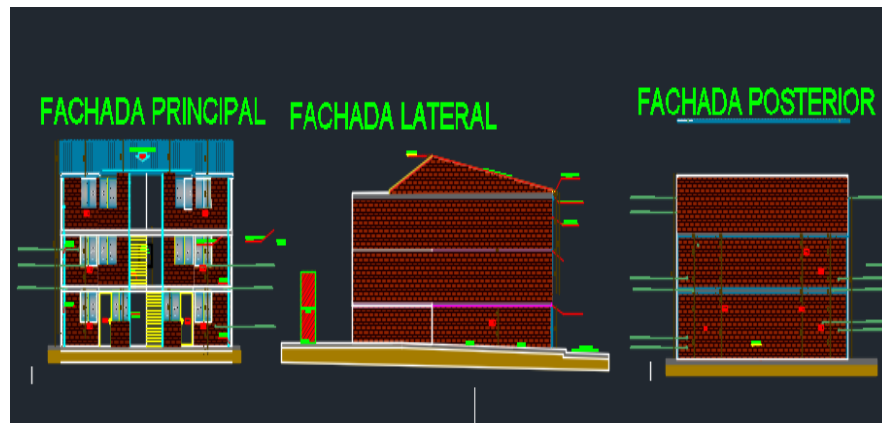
Diseño de fachadas edificio de viviendas para personas víctimas del conflicto armado. Fuente: Autor.
